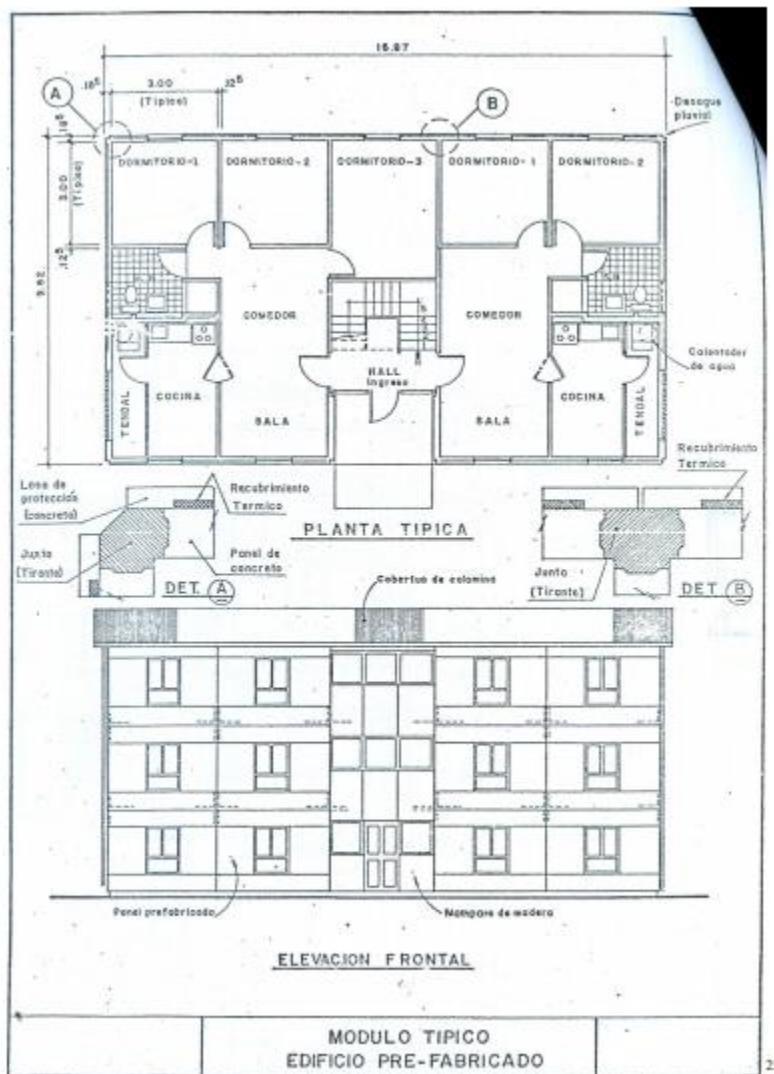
Edificio típico prefabricado, planta y elevación principal
